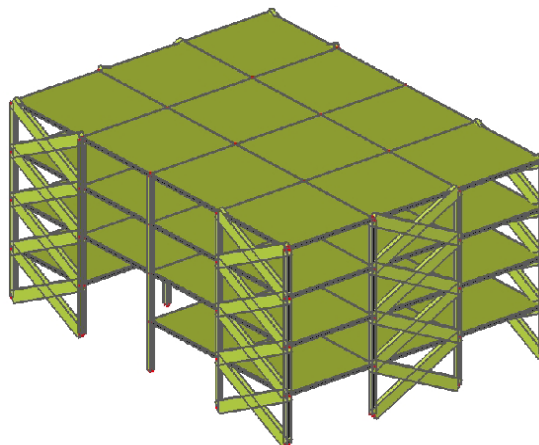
System 2, das Gebäude mit Mauerwerksausfachung (das Gebäude wurde mit Ziegelwänden ausgefacht).
